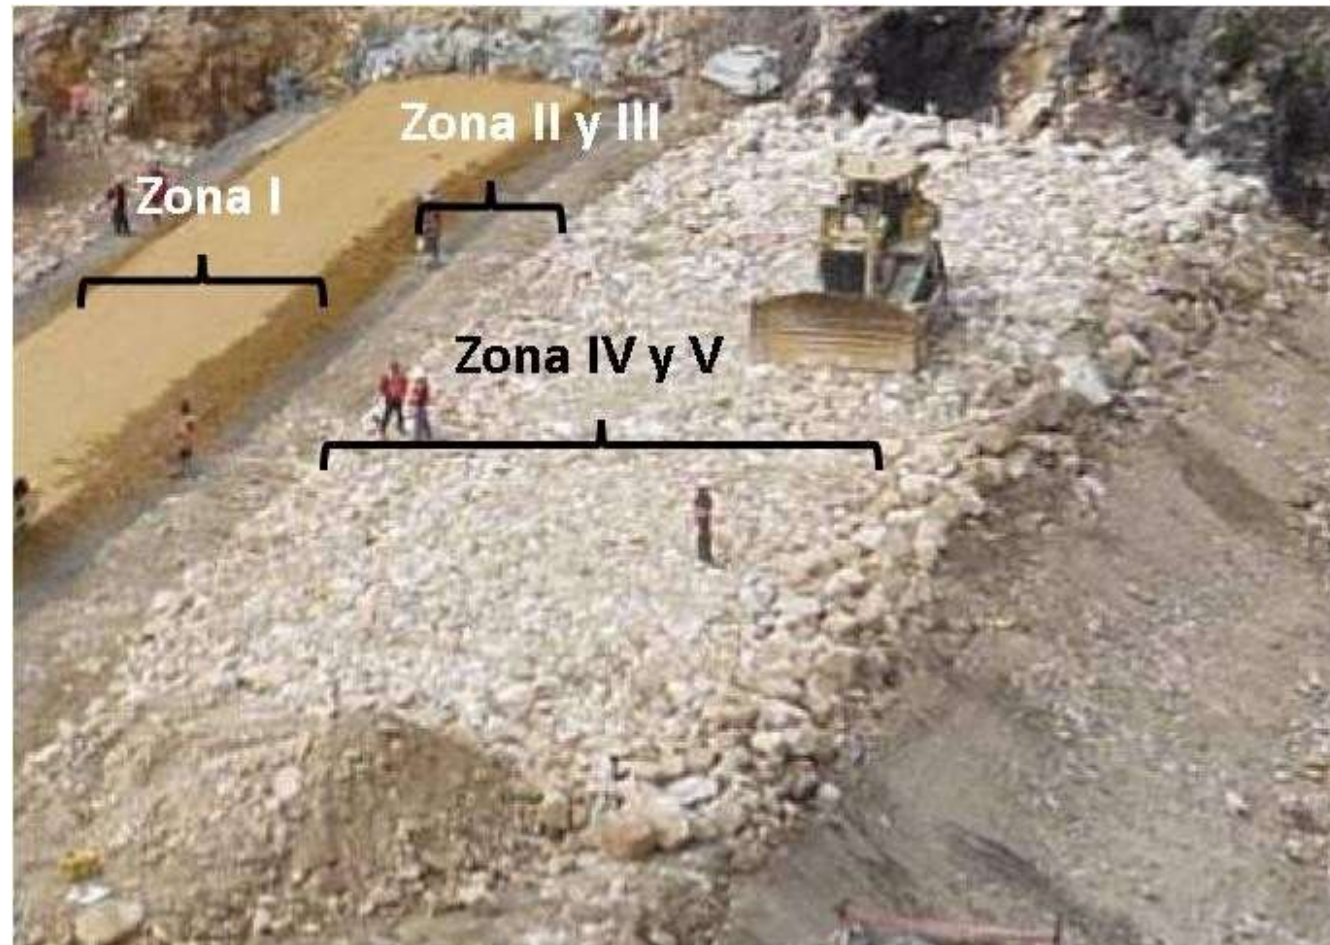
Vista en Planta del cuerpo de la Presa Principal
